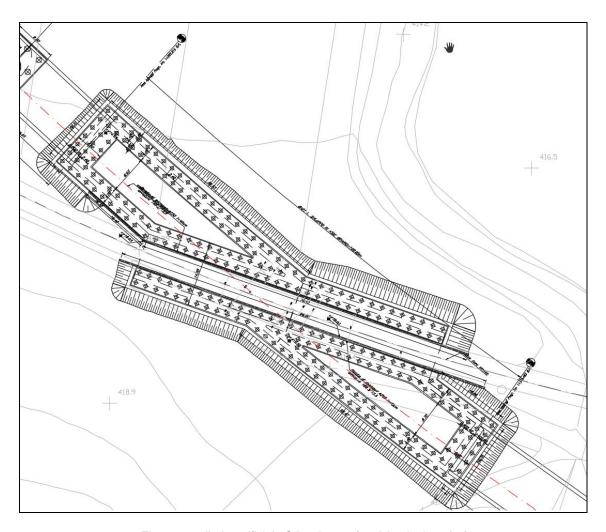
galleria artificiale GA01 lotto 3 (stralcio planimetrico)
